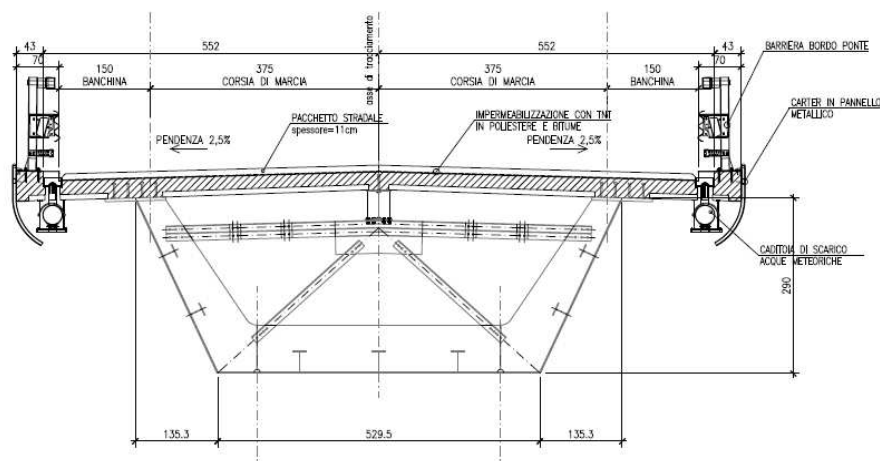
SEZIONE TRASVERSALE TIPO
